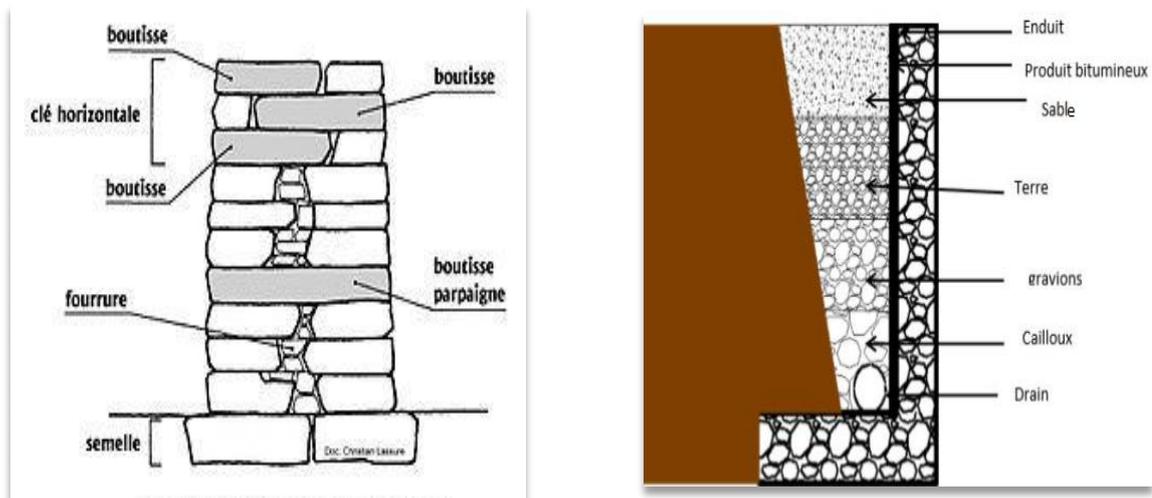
coupe d'un mur de soutènement en pierre sèche et son système de drainage
